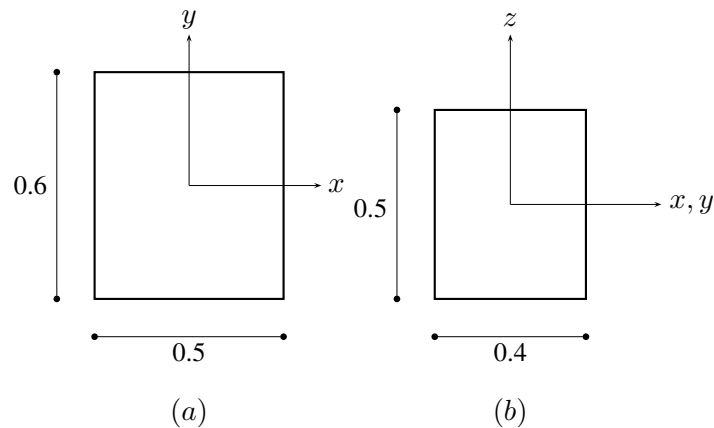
Secciones de las columnas (a) y las vigas (b).
